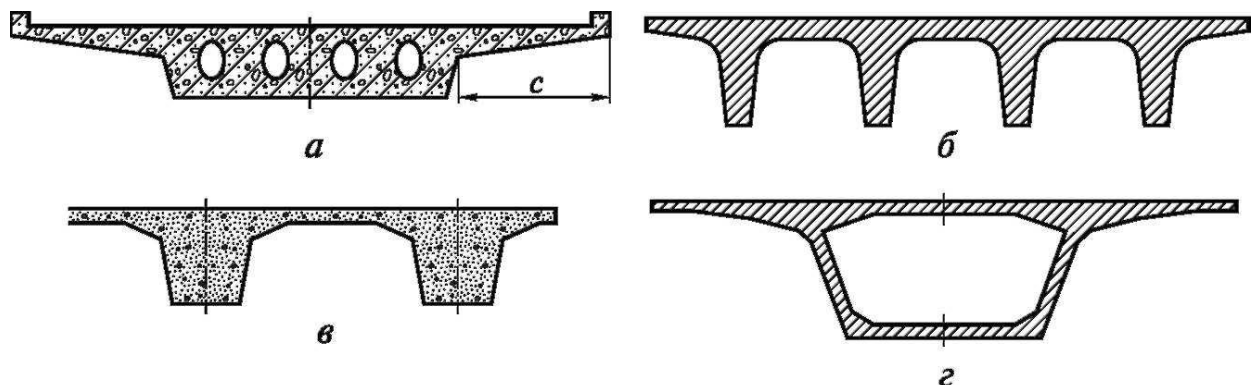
Типи поперечних перерізів балочних залізобетонних мостів:
